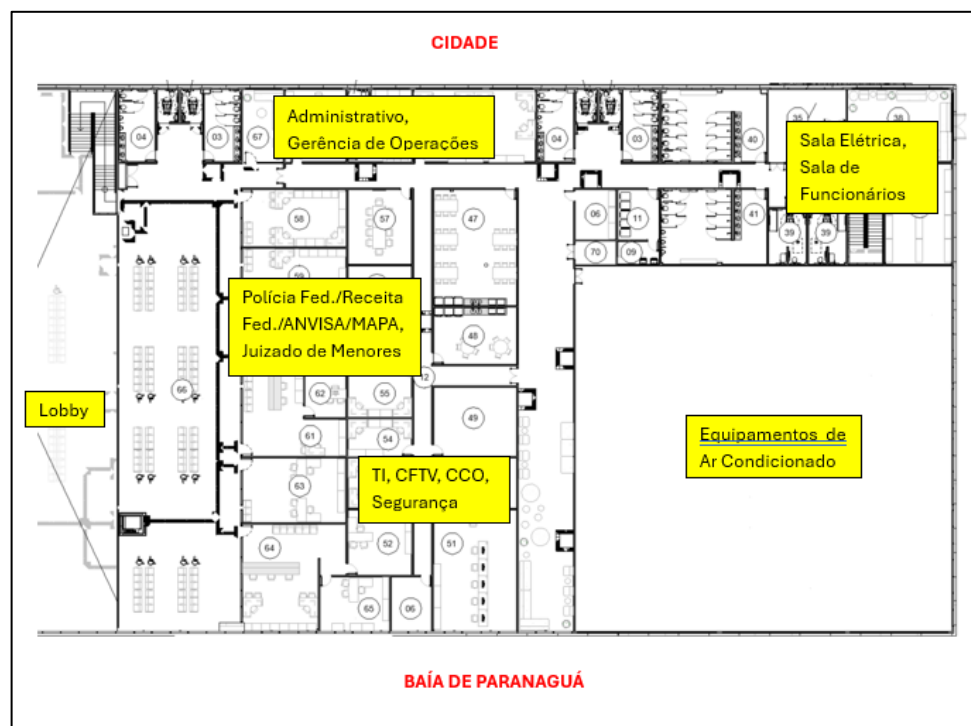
Layout Interno (1º Pavimento, lado Norte).
